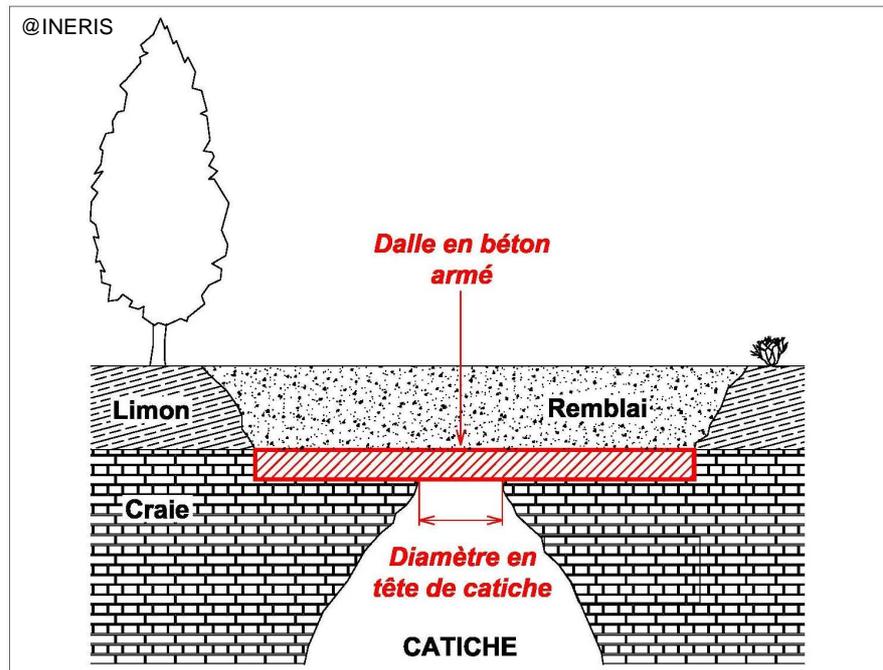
Schéma d'une dalle en béton armé fermant une catiche
